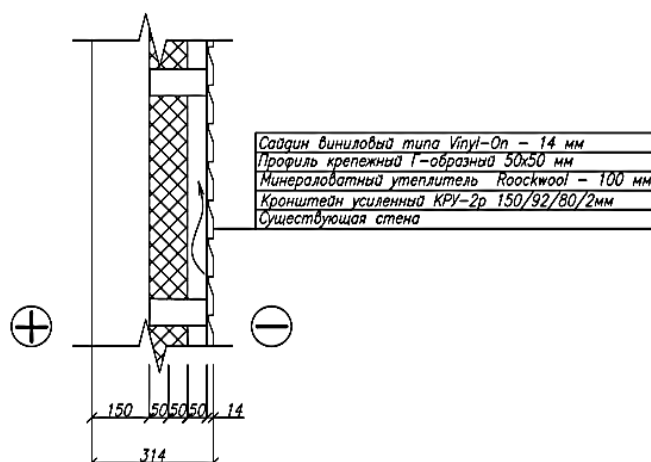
Навесная вентилируемая система с жёсткими теплоизоляционными плитами и облицовкой виниловым сайдингом
